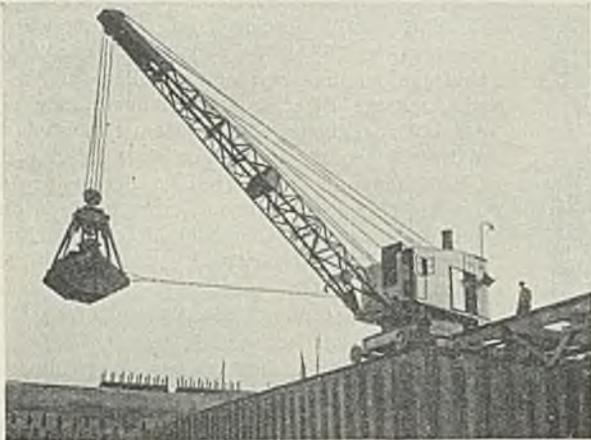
Dampf-Greifbagger MV am Außenhaupt.
